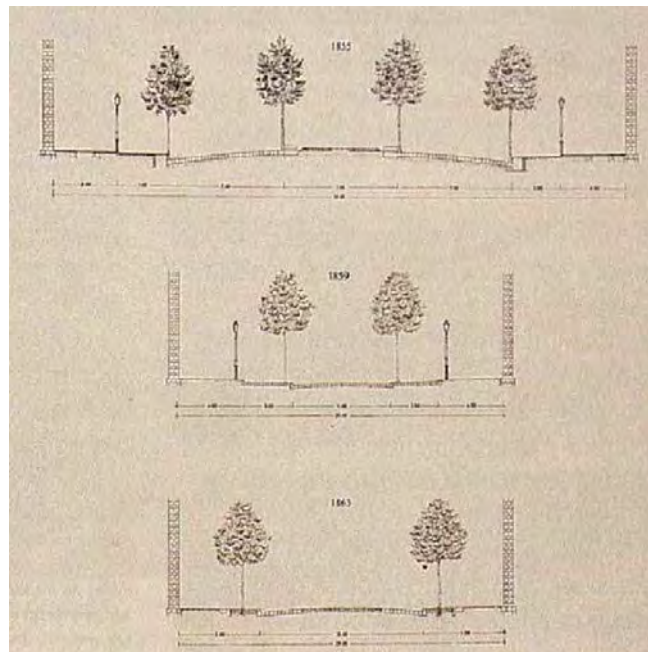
Secciones de las calles del Ensanche del Plan Cerdá
